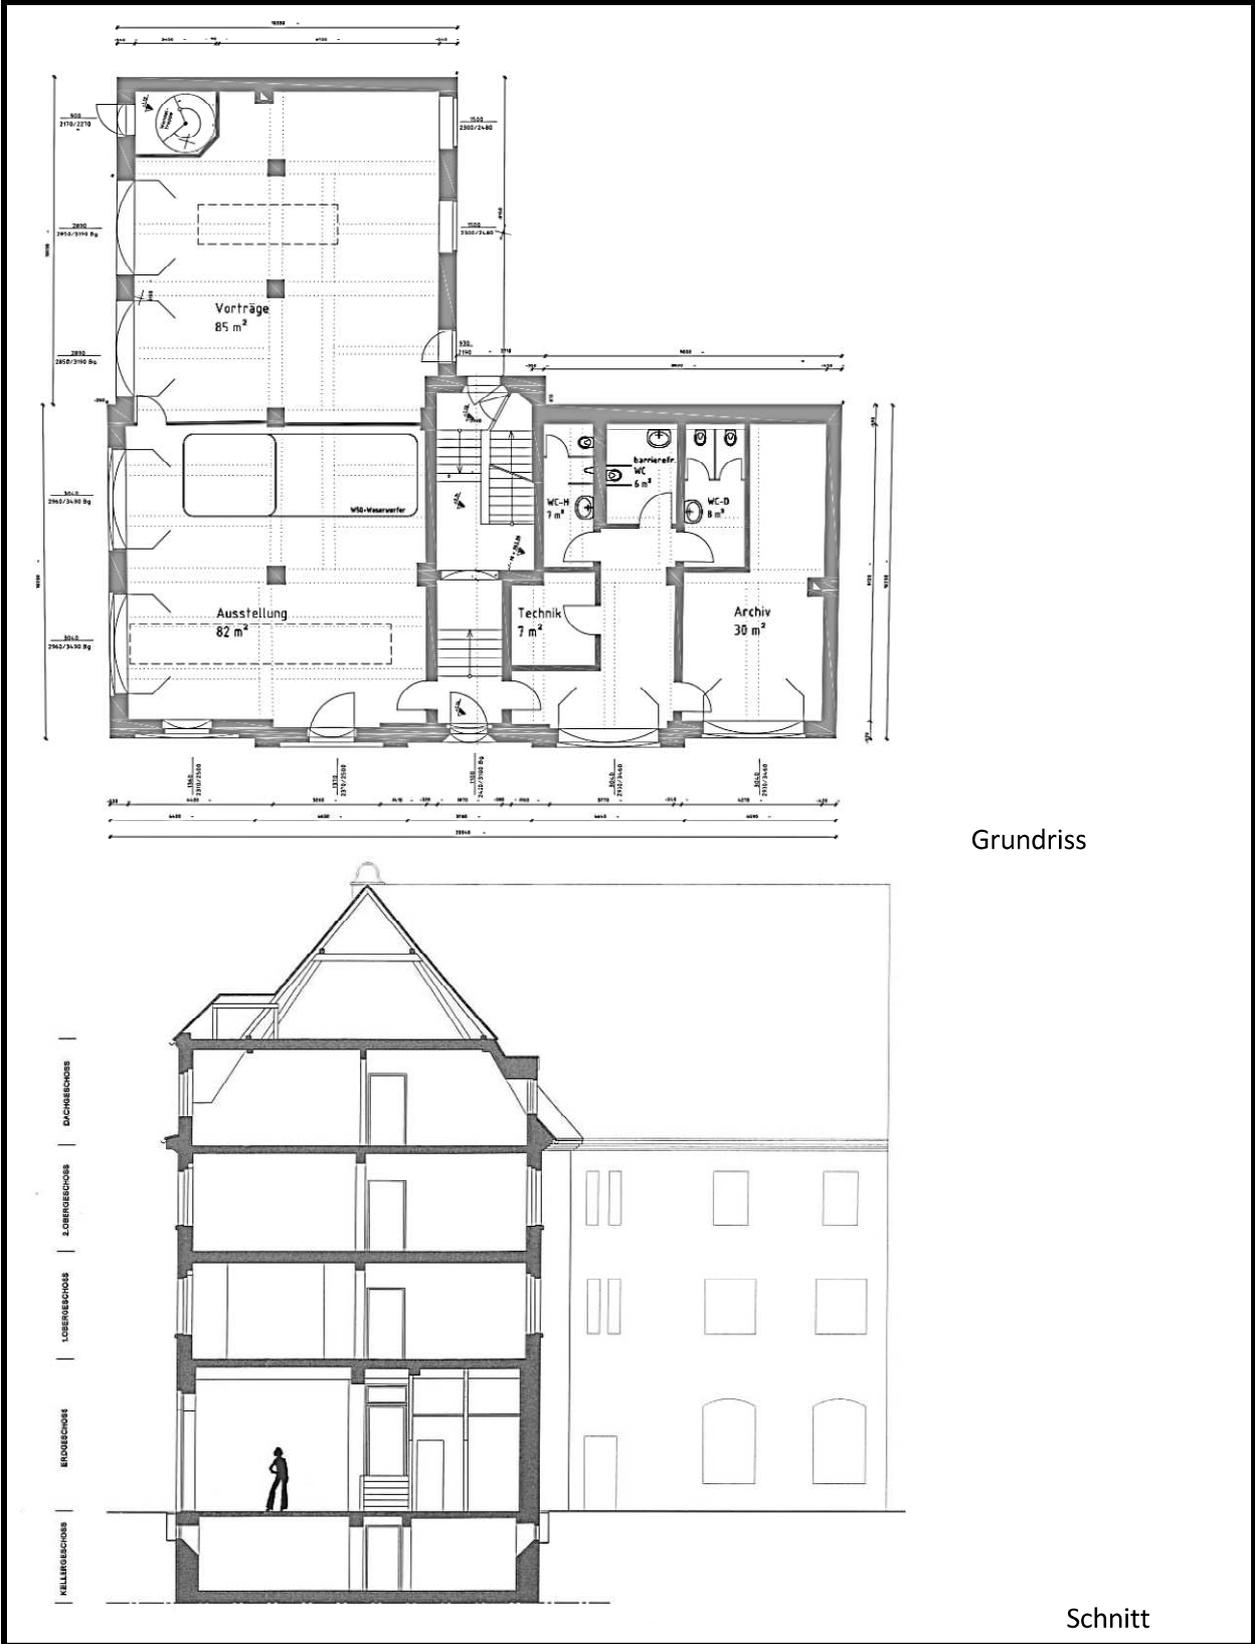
Grundriss und Schnitt Standort Melanchthonstraße
